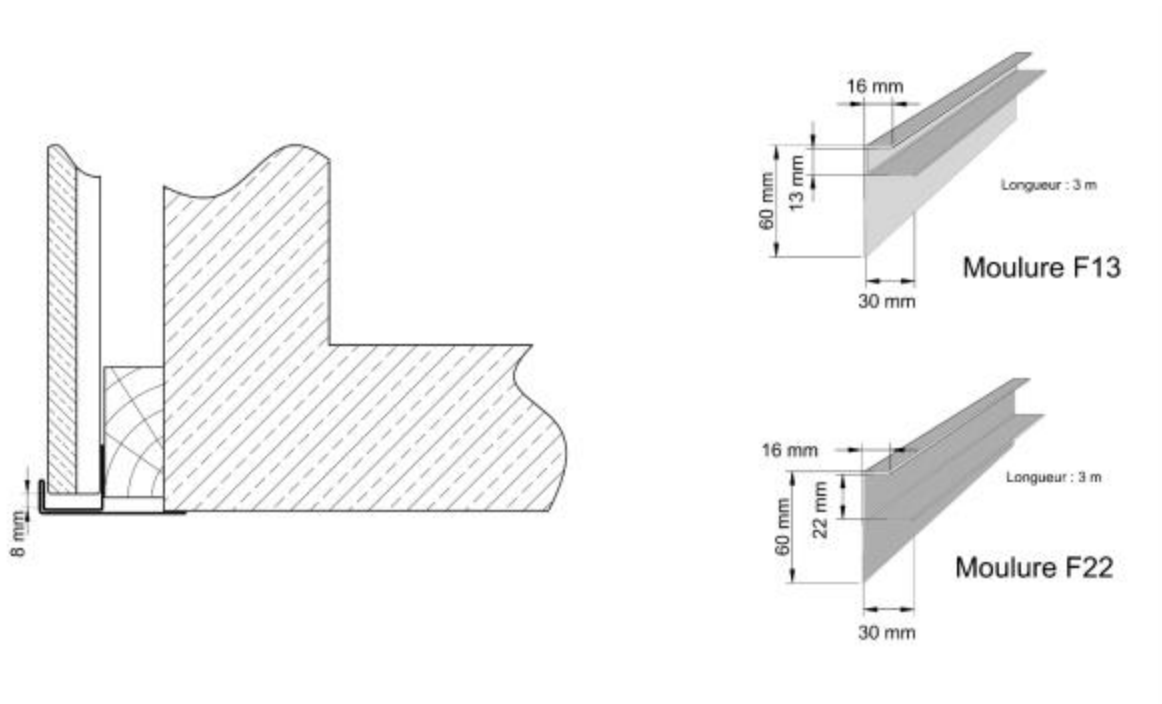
Arrêt latéral sur revêtement – Mouldure F
